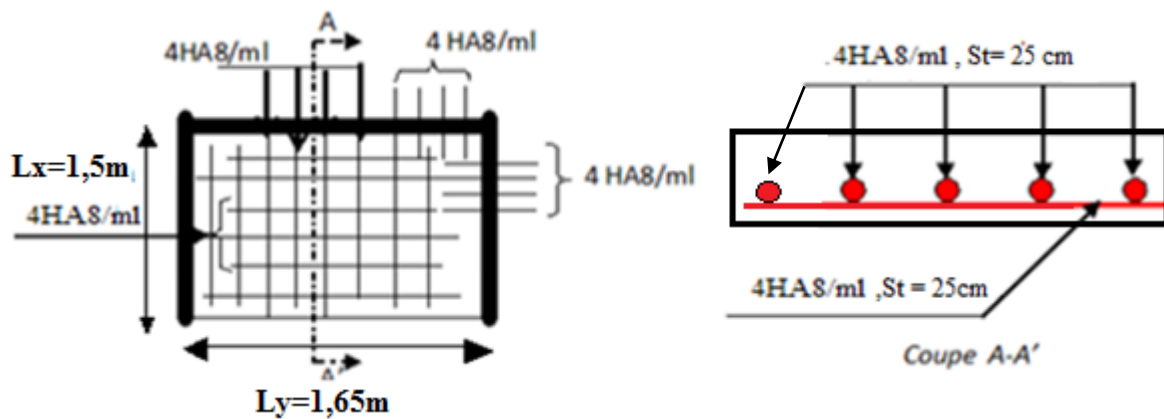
Schéma de ferrailage de la dalle sur 3 appuis (balcon étage courant)
